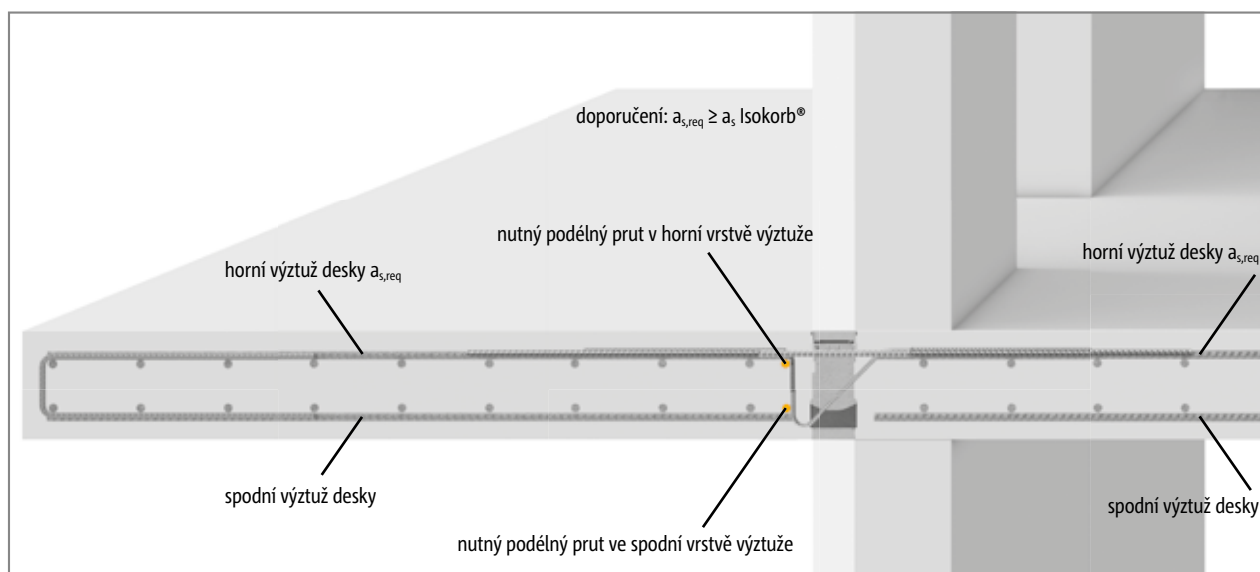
Schöck Isokorb® typ K: Délka přesahu l_0 , krytí výztuže CV
